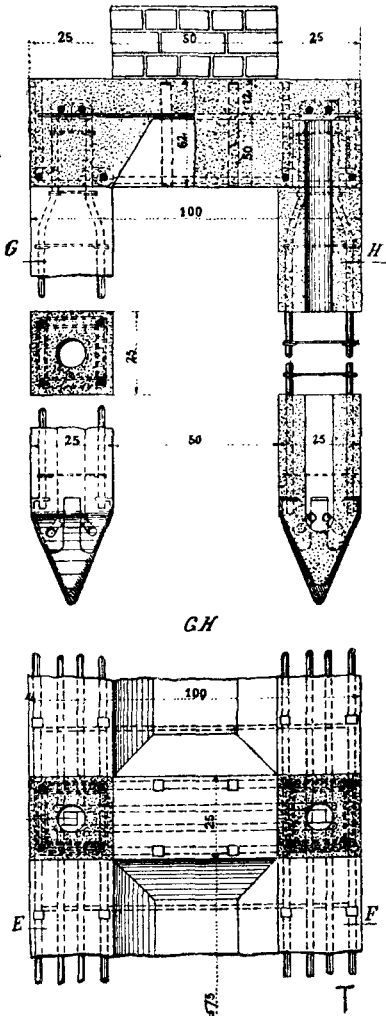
Fundament domu Hallenbeck w N. Yorku (G. C. 1904 s. 172); dom ma 10 pięter. Pale zapuszczane były prądem wody. Połączone są płytą żelazno-betonową. Dźwigary I 50 cm wysokie przenoszą na nie ciśnienie kolumny i ściany, a okryte są drugim pokładem betonu.
